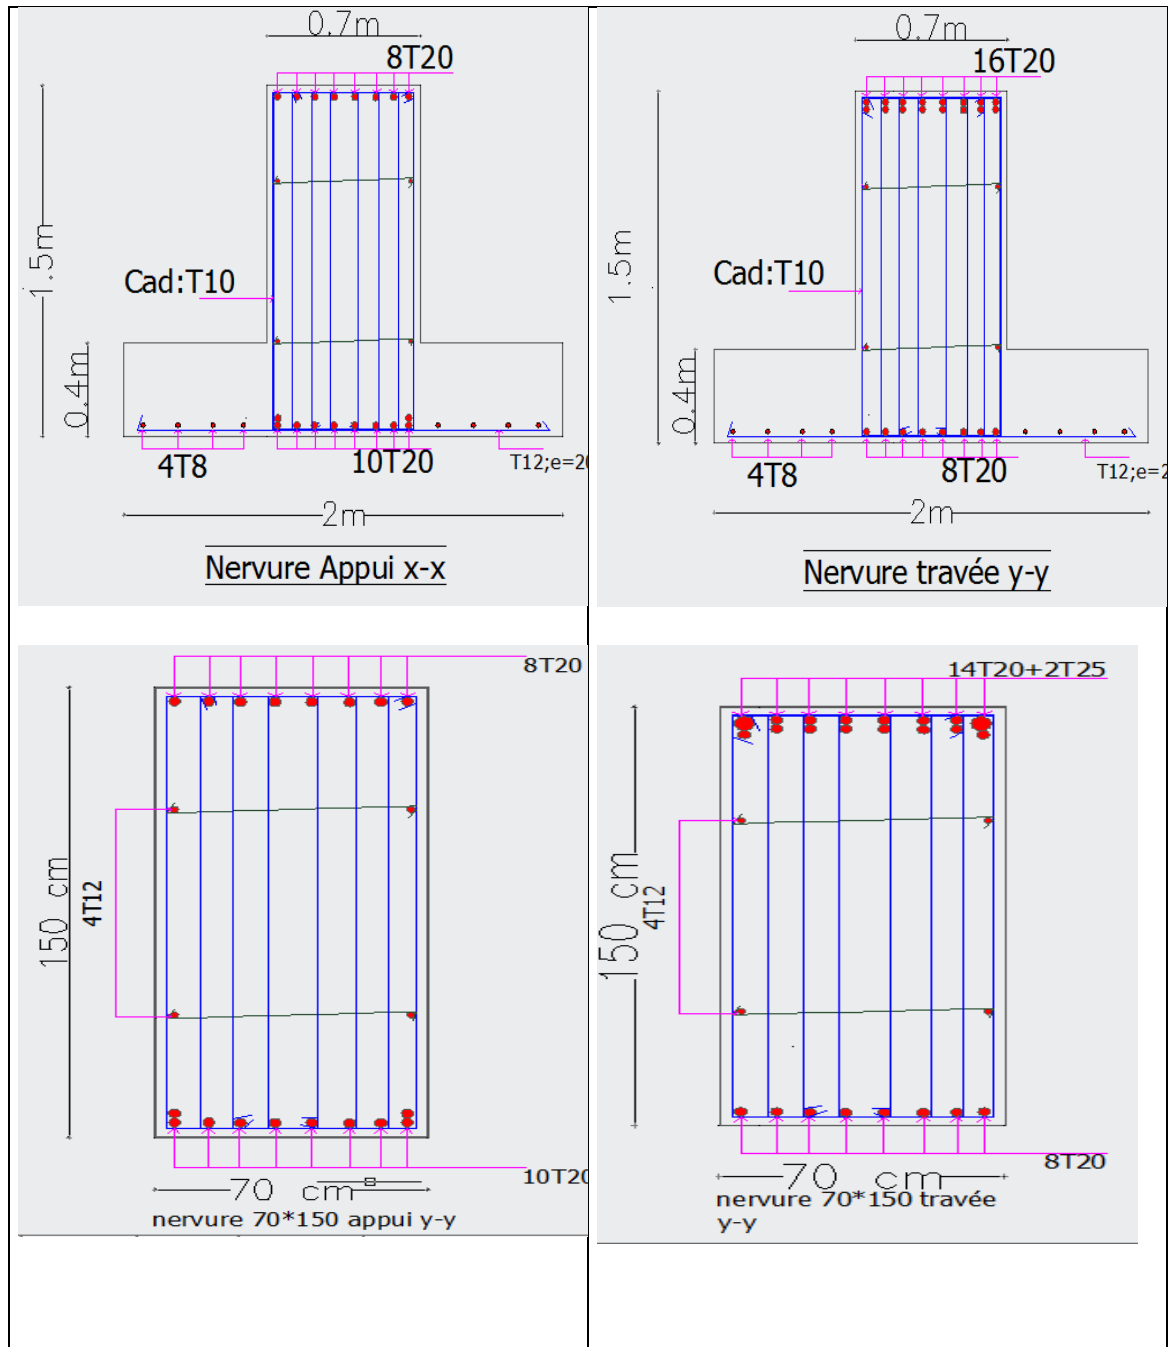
Schéma de ferrailage de la semelle suivant Y-Y.
